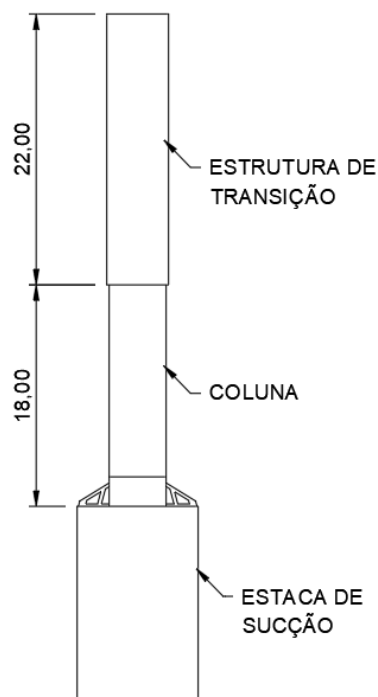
Ilustração do conjunto de estruturas a ser instalado. Fonte: Elaborado pela autora.
